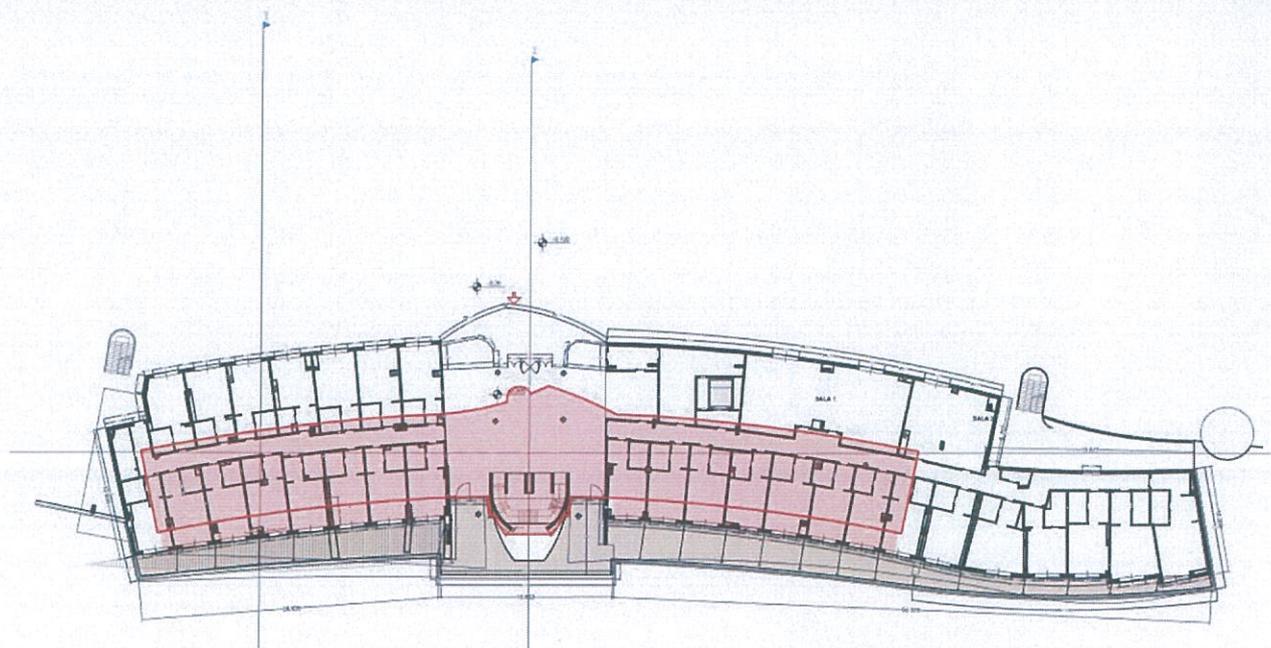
Planimetri e katit përdhe (kuota 0.00)
